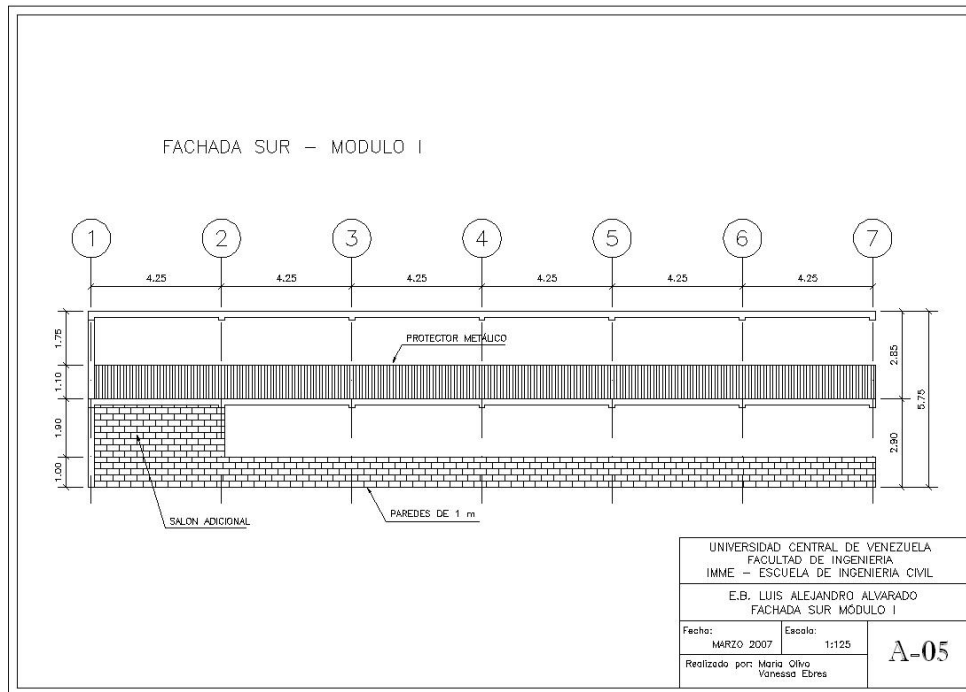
Plano de la Fachada Sur del Módulo I.
